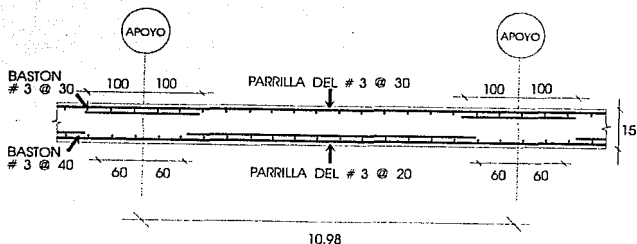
ARMADO DE LA LOSA DE CIMENTACION
